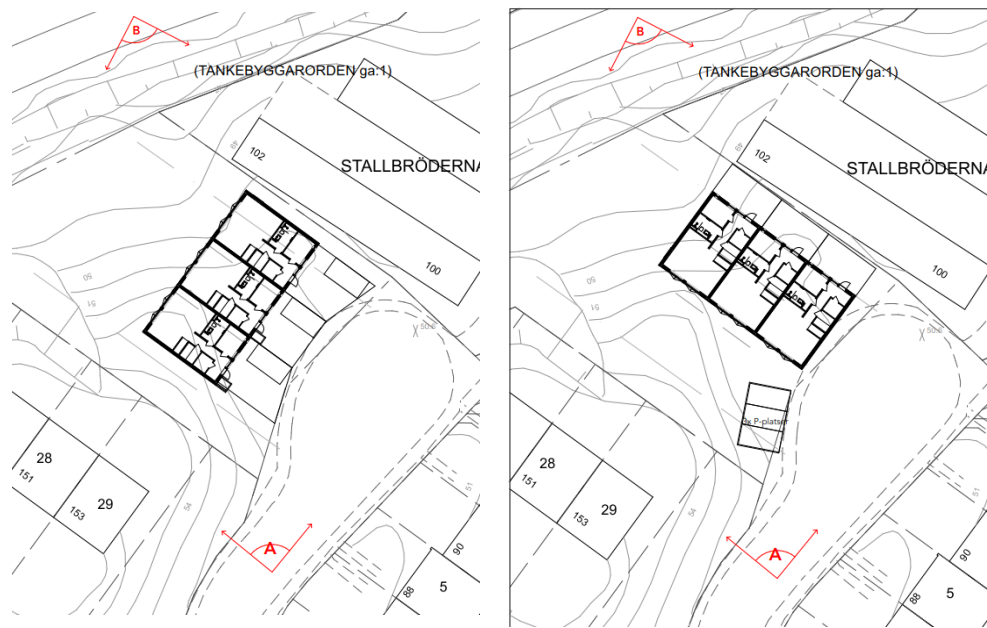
Planerad utformning enligt situationsplan – Järnbärarvägen, daterad 2024-12-12.
